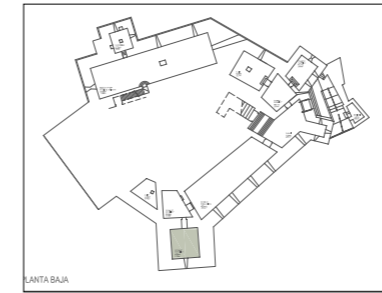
Localización en planta de la cámara bajo la torre suroeste
